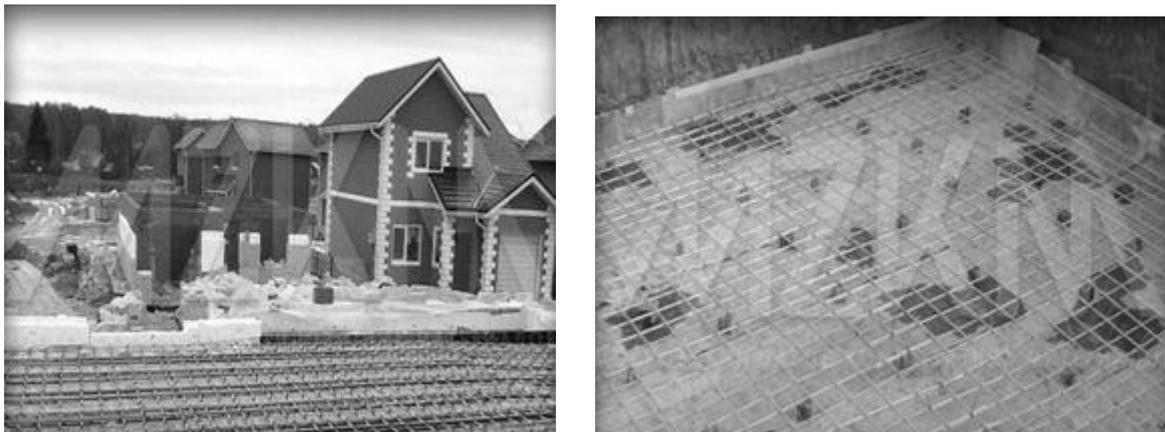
Применение АНК для армирования фундаментной плиты \
